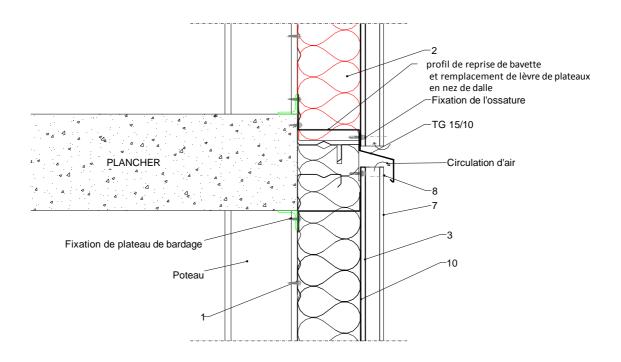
Fractionnement au droit de chaque plancher en zone sismique – Coupe verticale
